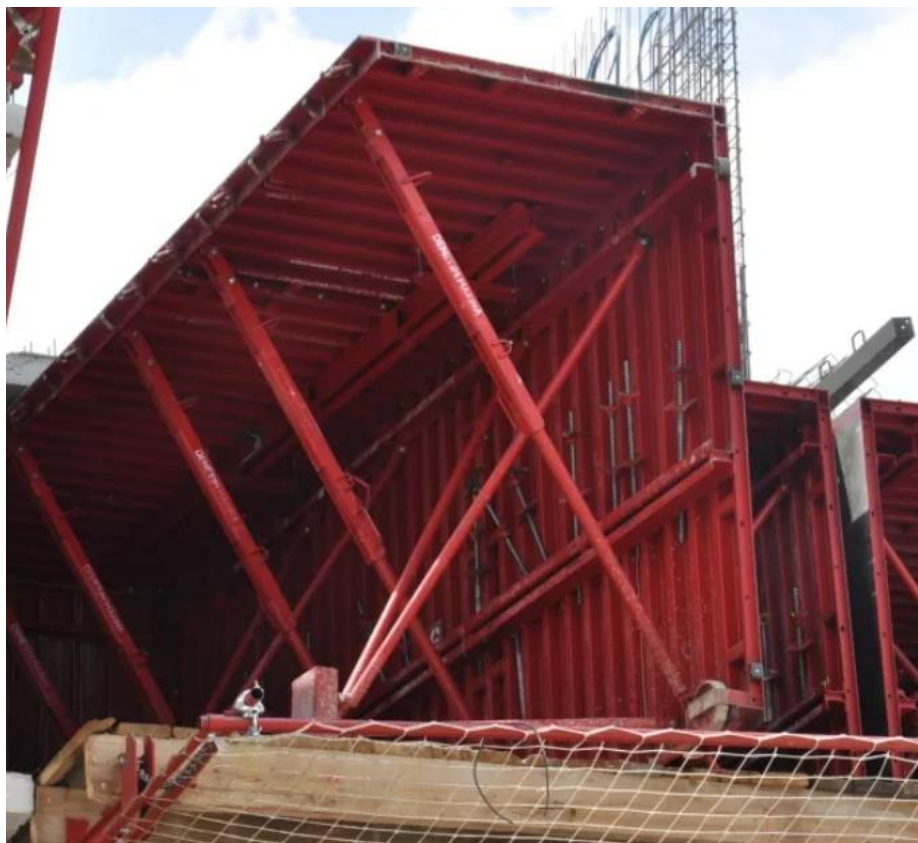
Туннельная металлическая опалубка фирмы "Outinord"
